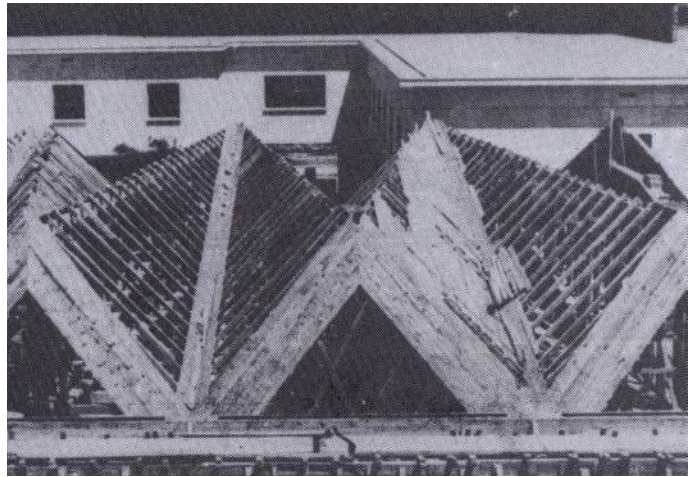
MONTAJE FINAL ENCOFRADOS
